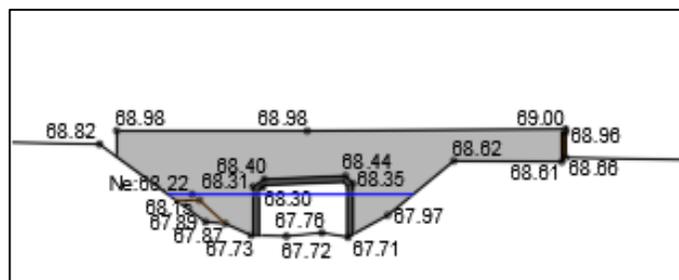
Pont au droit de la zone de débordement vers le plan d'eau du Canada
